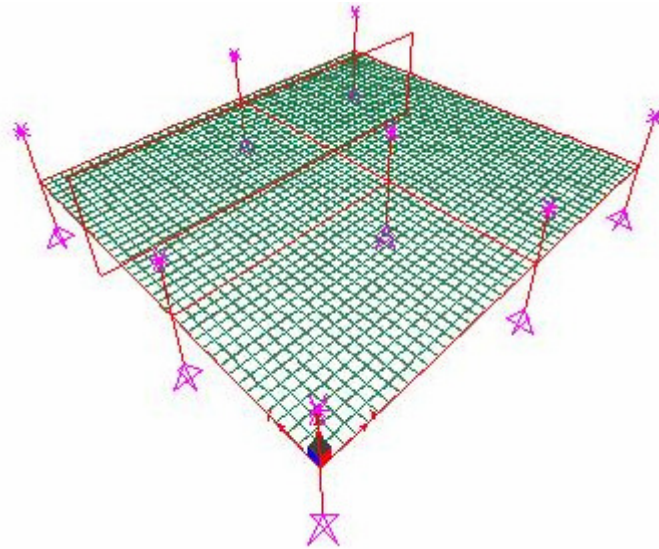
Seção sobre as lajes 1 e 3 – modelo 6
